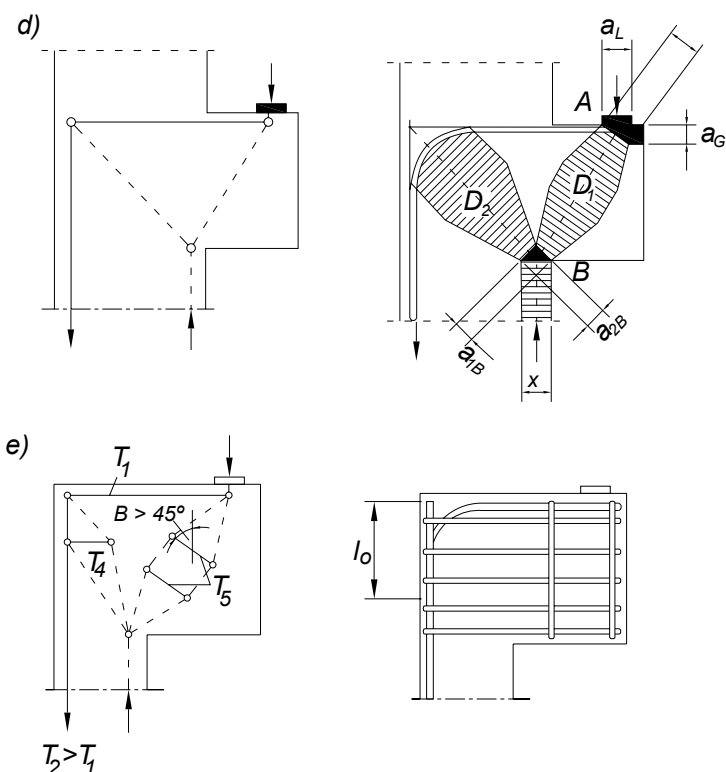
(Cont.) – Diferentes condiciones de apoyo que conducen a diferentes modelos de bielas y tirantes y diferentes disposiciones de armadura en las cartelas y resaltos horizontales tipo viga (*Schlaich et al. 1987*)
